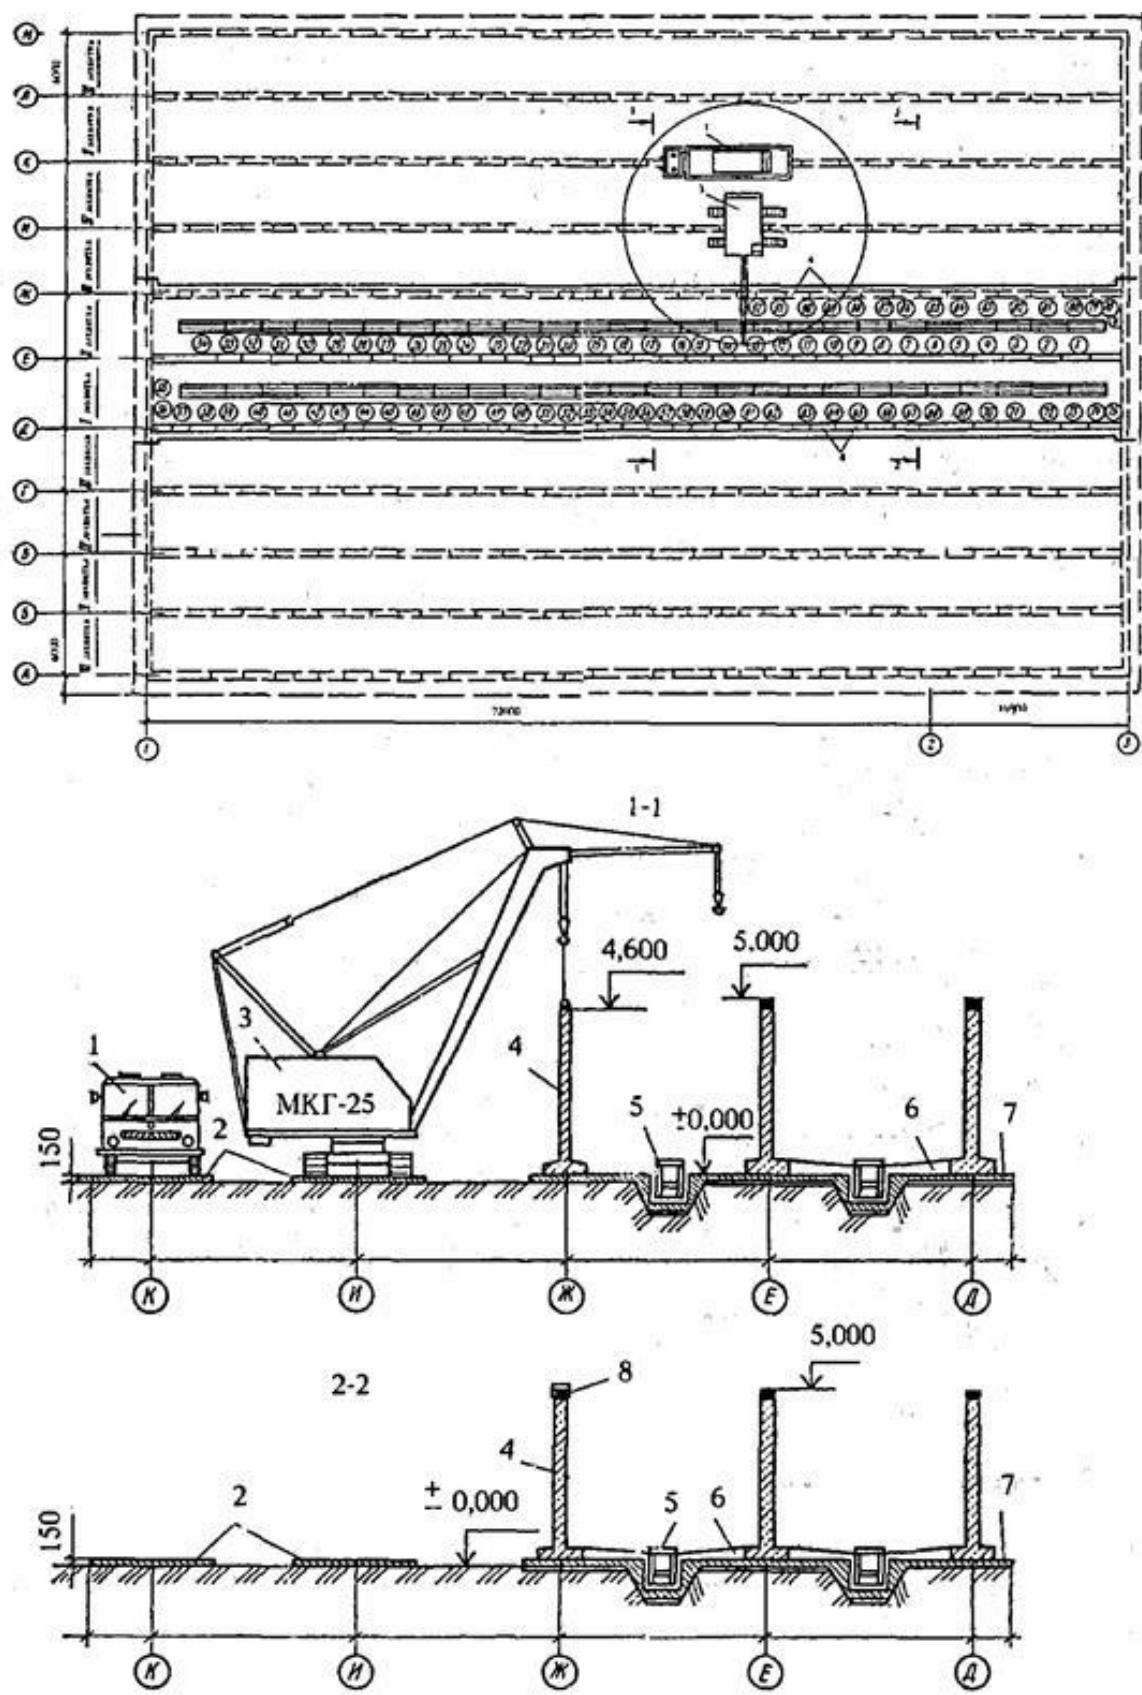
Схема организации монтажа горизонтального отстойника гусеничным краном:
